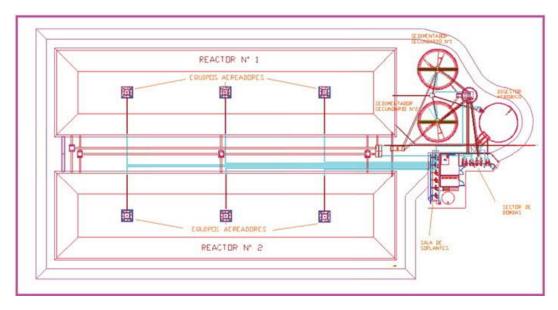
Layout de Planta de Tratamiento de Efluentes.
